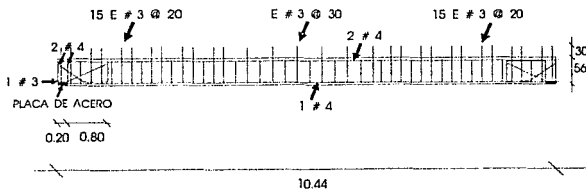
SECCION LONGITUDINAL DE LAS "DOBLES T"
